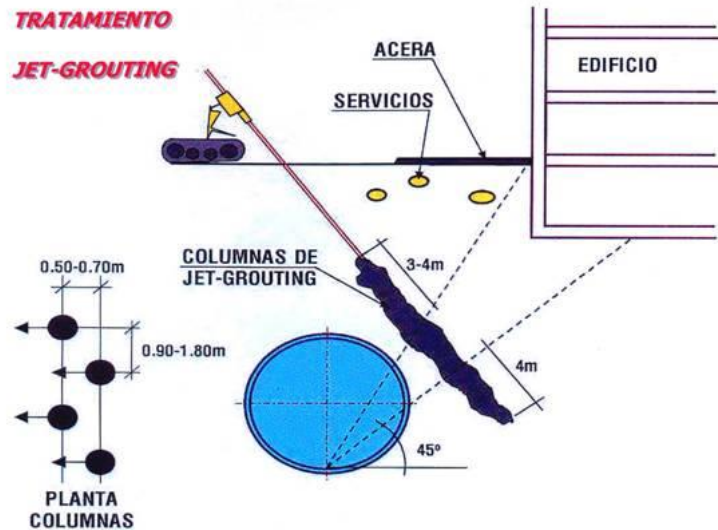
Disposición en planta y alzado de los tratamientos de protección con Jet-grouting.
